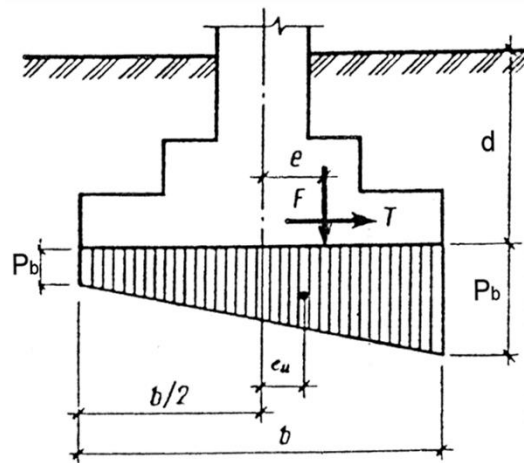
Епюра граничного тиску під подошвою фундаменту за сейсмічного впливу
